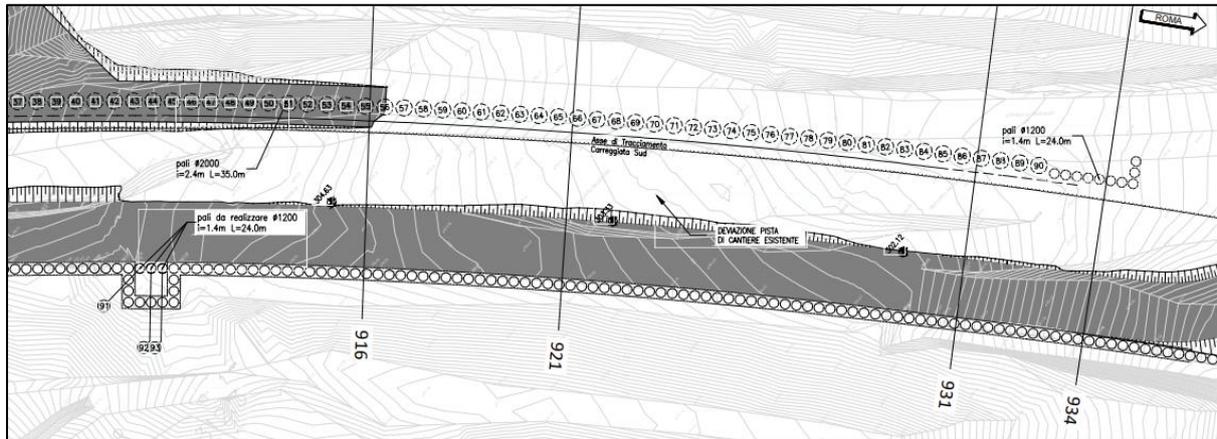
FASE 1 Planimetria area intervento (2 di 2)
